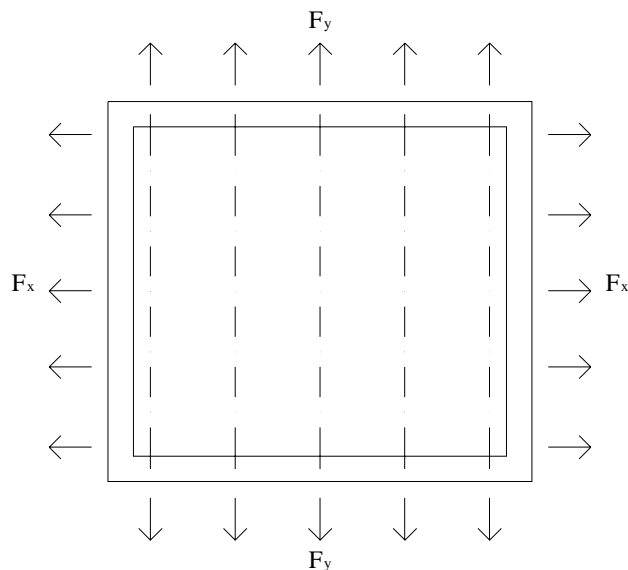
Schématisation des poutres d'un plancher portant dans un sens
